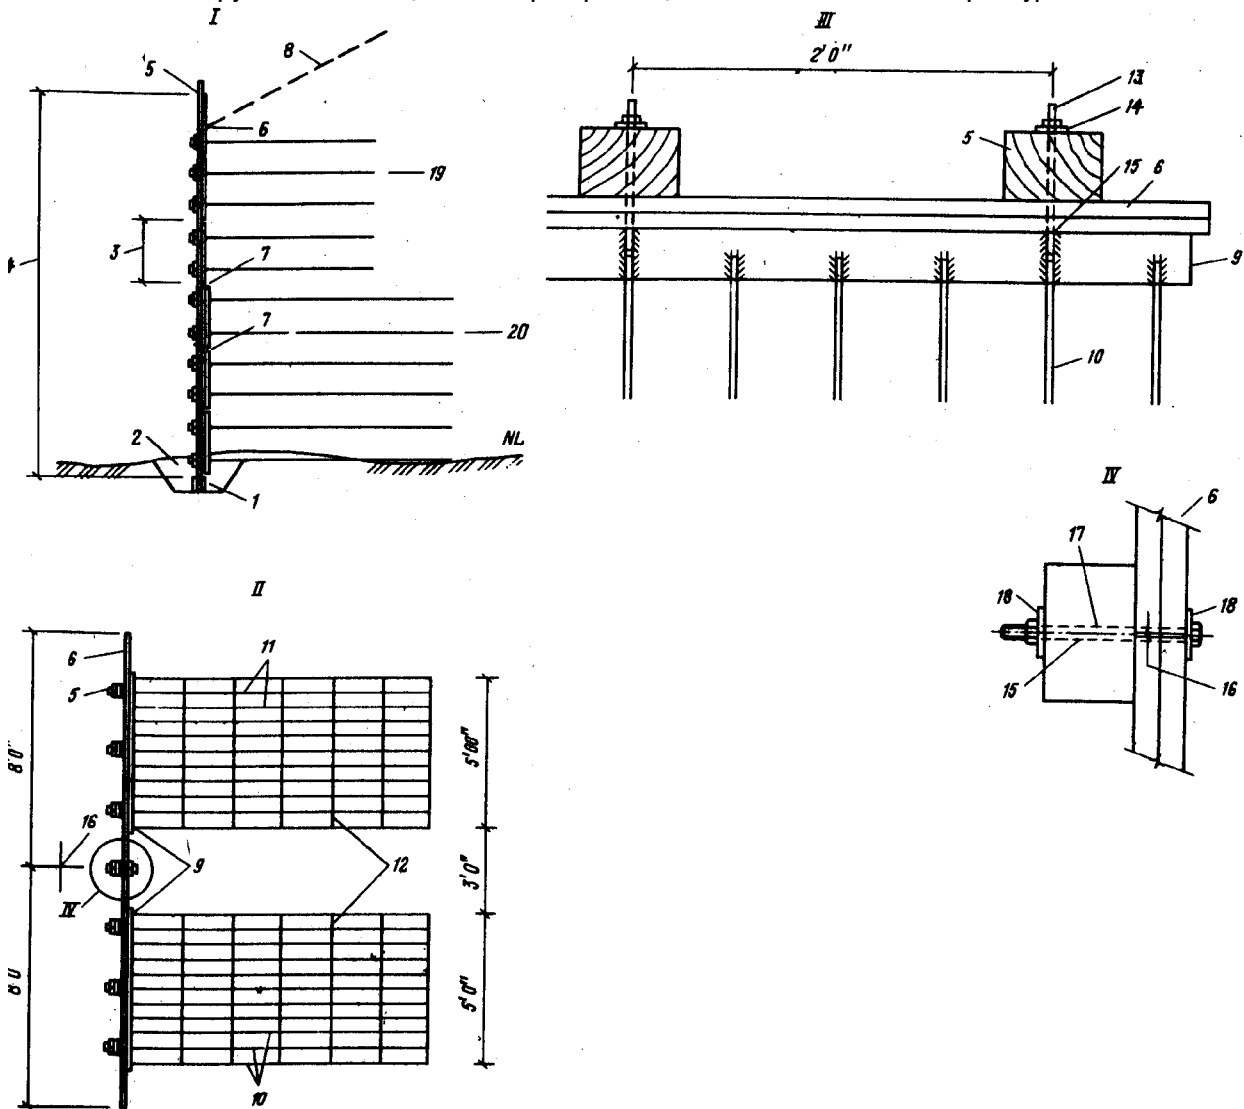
Сооружение, облицованное железобетонными панелями и армированное металлической сеткой
